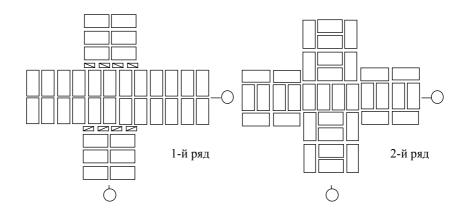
Кладка пересечений стен толщиной в 1,5 кирпича
